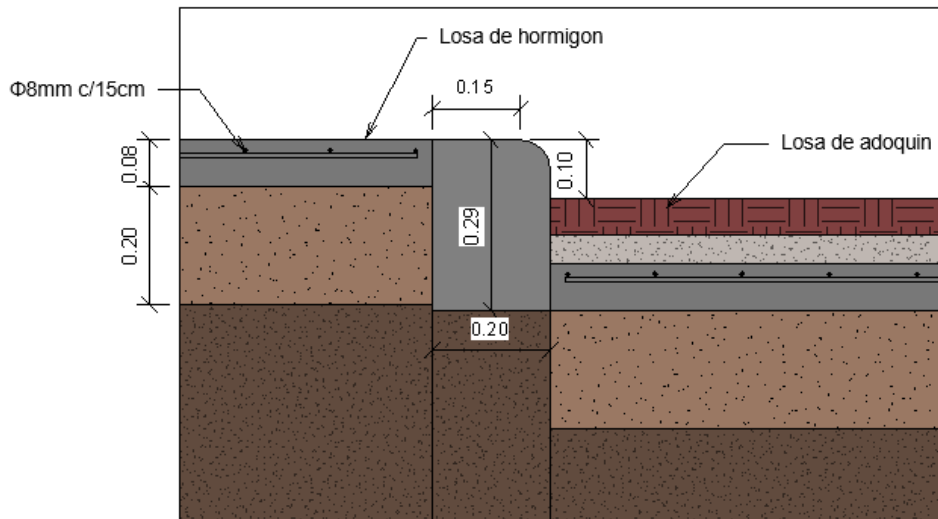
Vista en corte de losas de hormigón. (Bodero & Romero, 2022)
